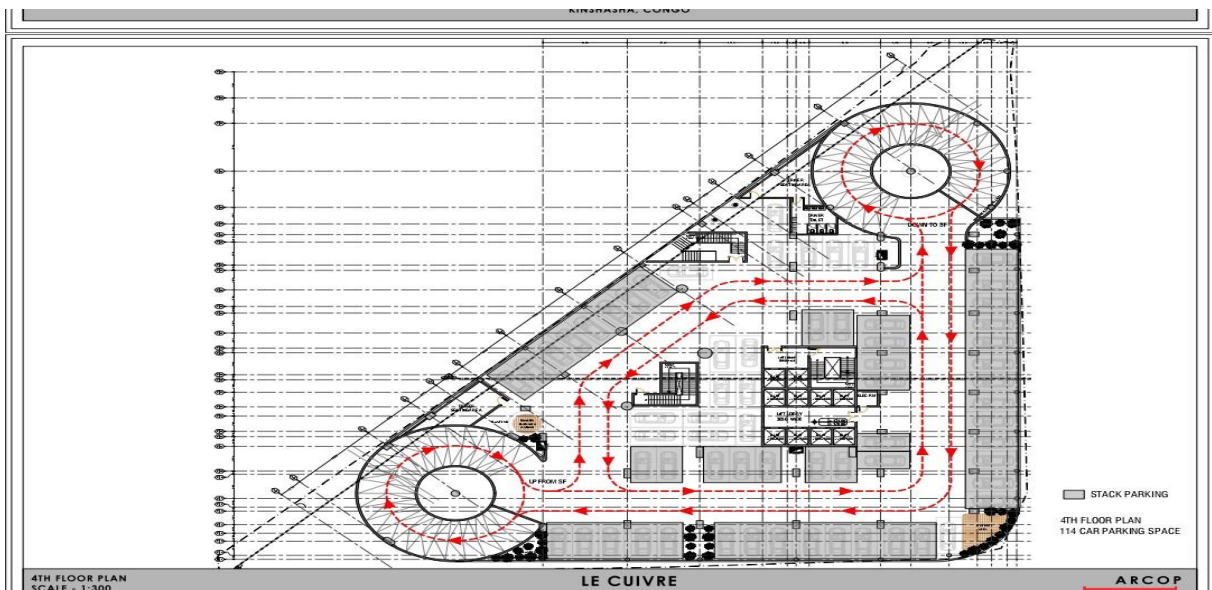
croquis du 4^e niveau avec un parking d'une capacité 114 places.
